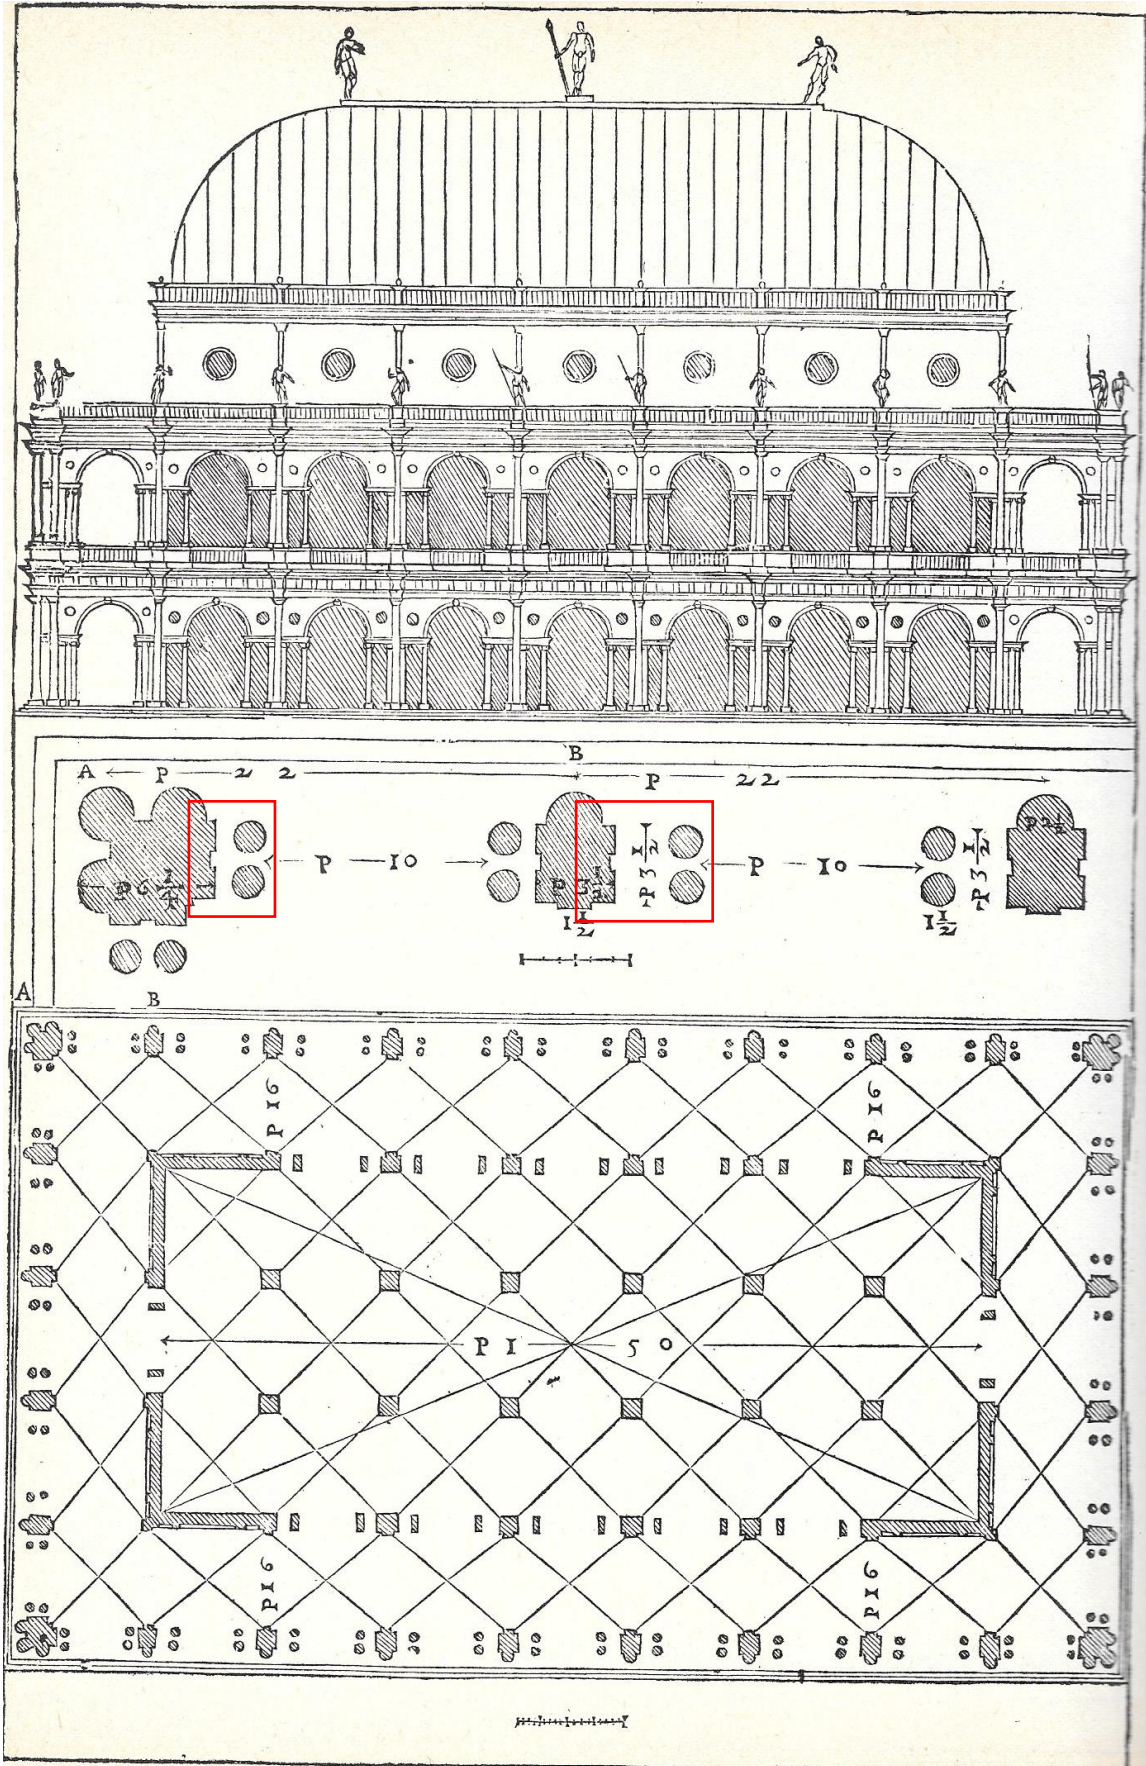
Andrea Palladio, Pianta, e alzato, con la pianta di parte dei pilastri in forma grande (Terzo libro dell'Architettura, pag.42)
